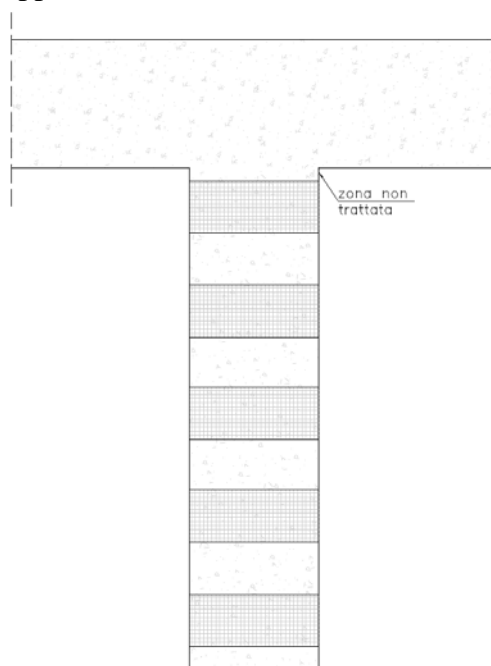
Dettaglio di intervento di solo confinamento (prospetto)
